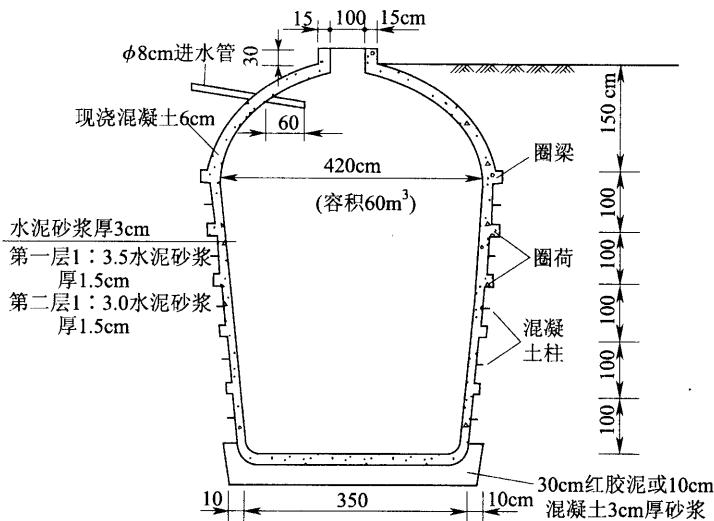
混凝土顶拱和带砂浆铆钉的水泥砂浆薄壁水窖剖面(单位:cm)
